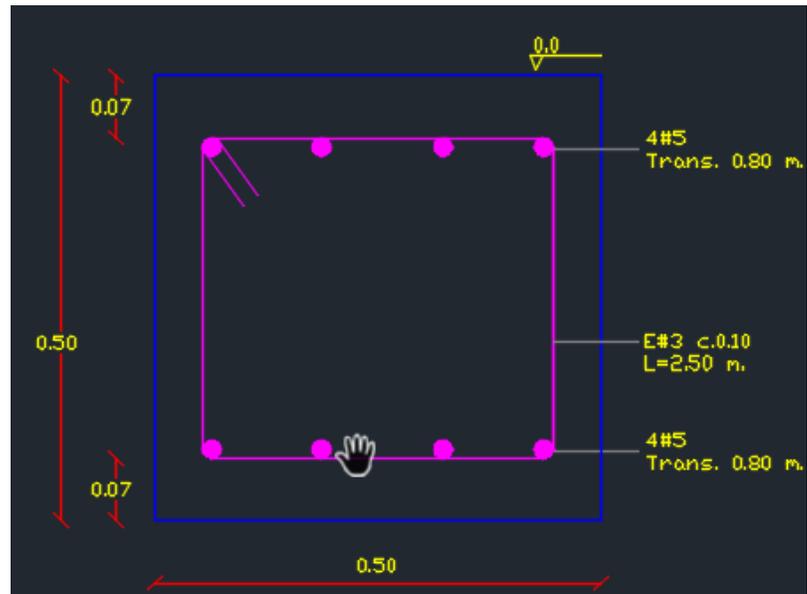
Viga de cimentación – Corte Z1-Z1. Fuente: Propia
